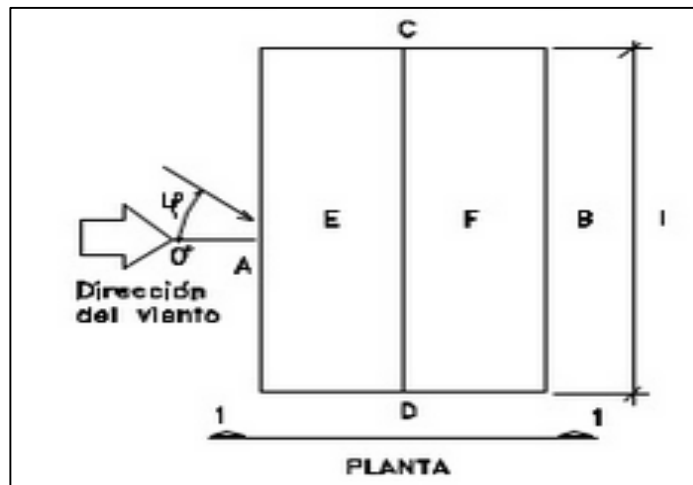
Planta de un edificio con cubierta de dos aguas.
